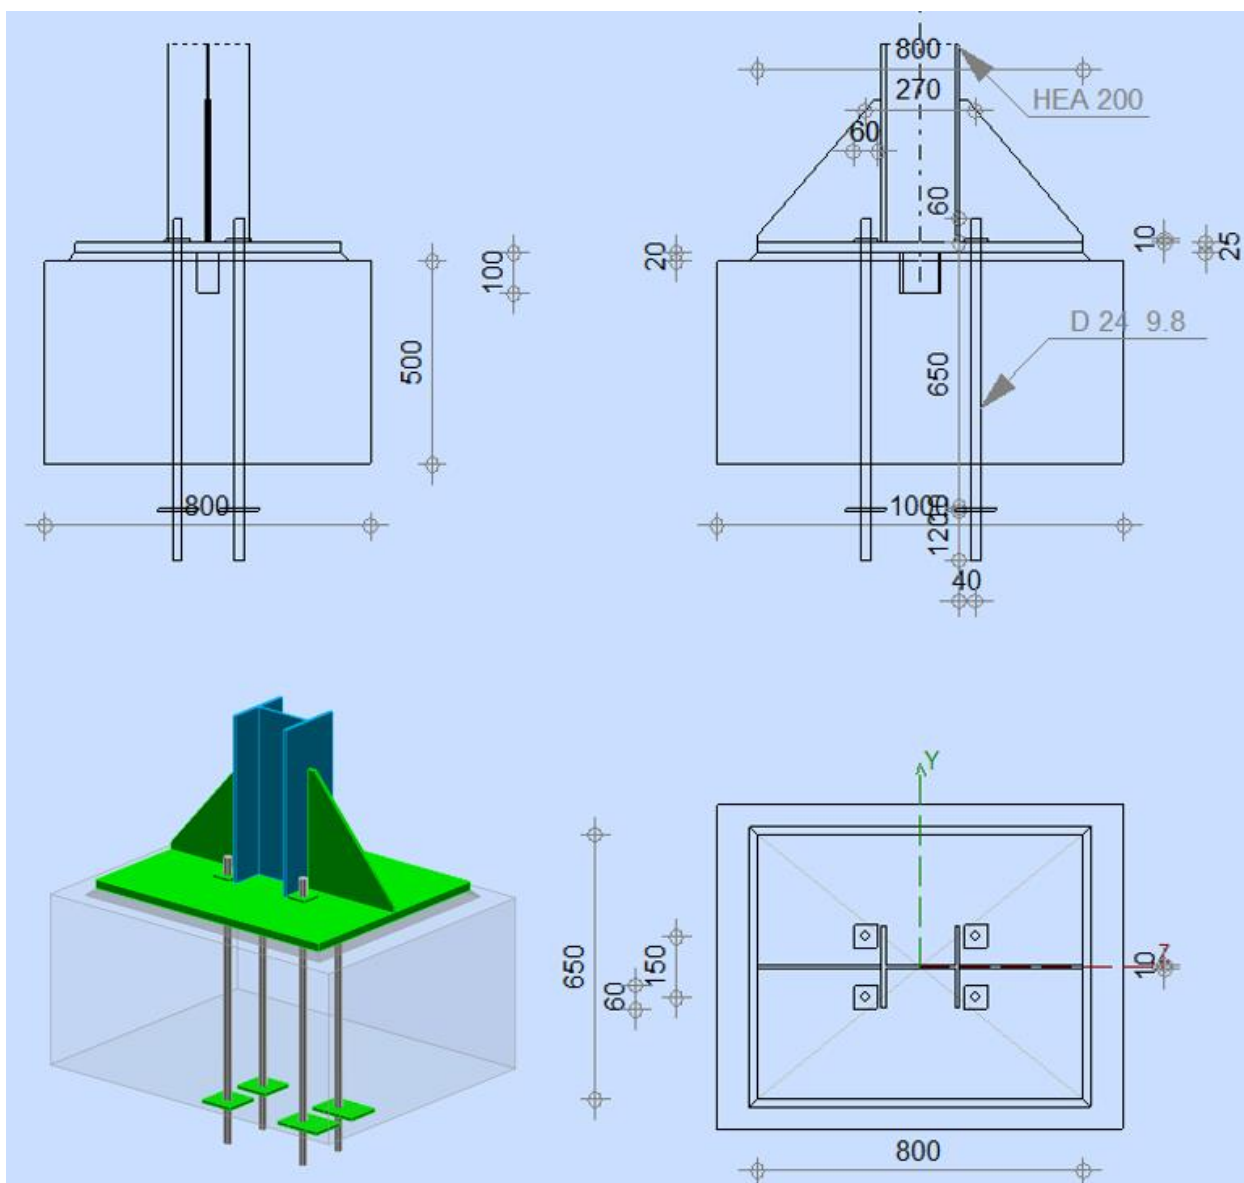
Representação da ligação entre o pilar e fundação para o pilar de fachada
